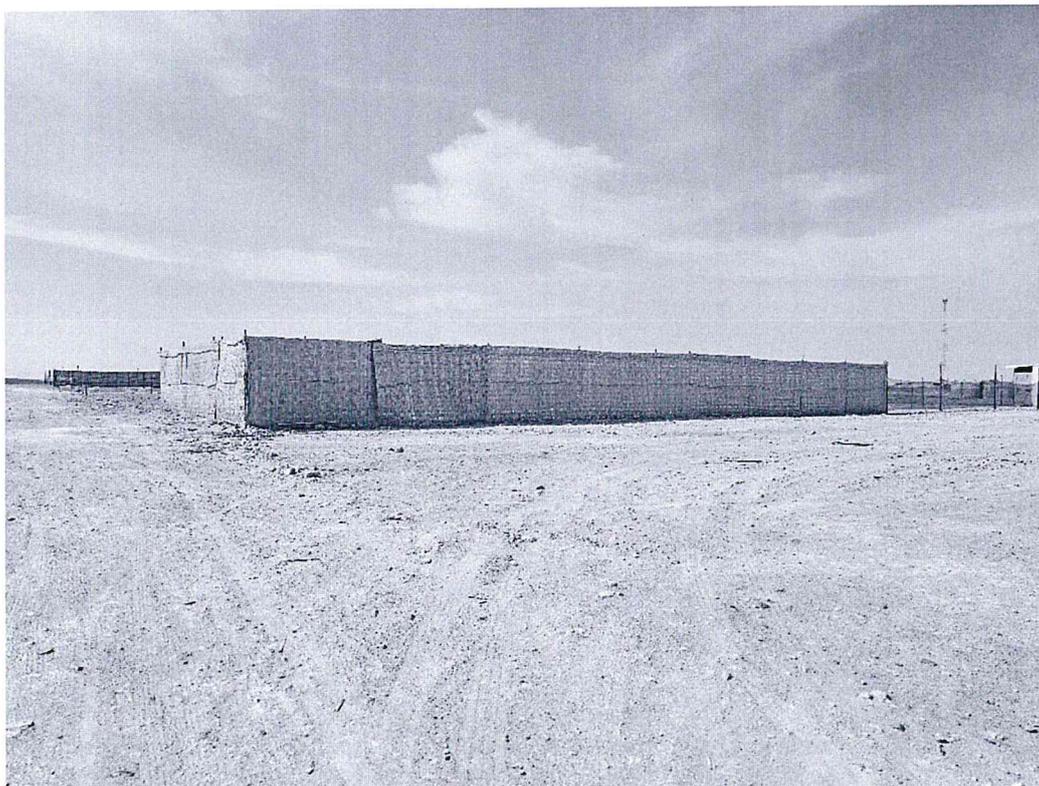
Vista de la apertura de calles y las áreas donde se realizaron remoción de tierra.
